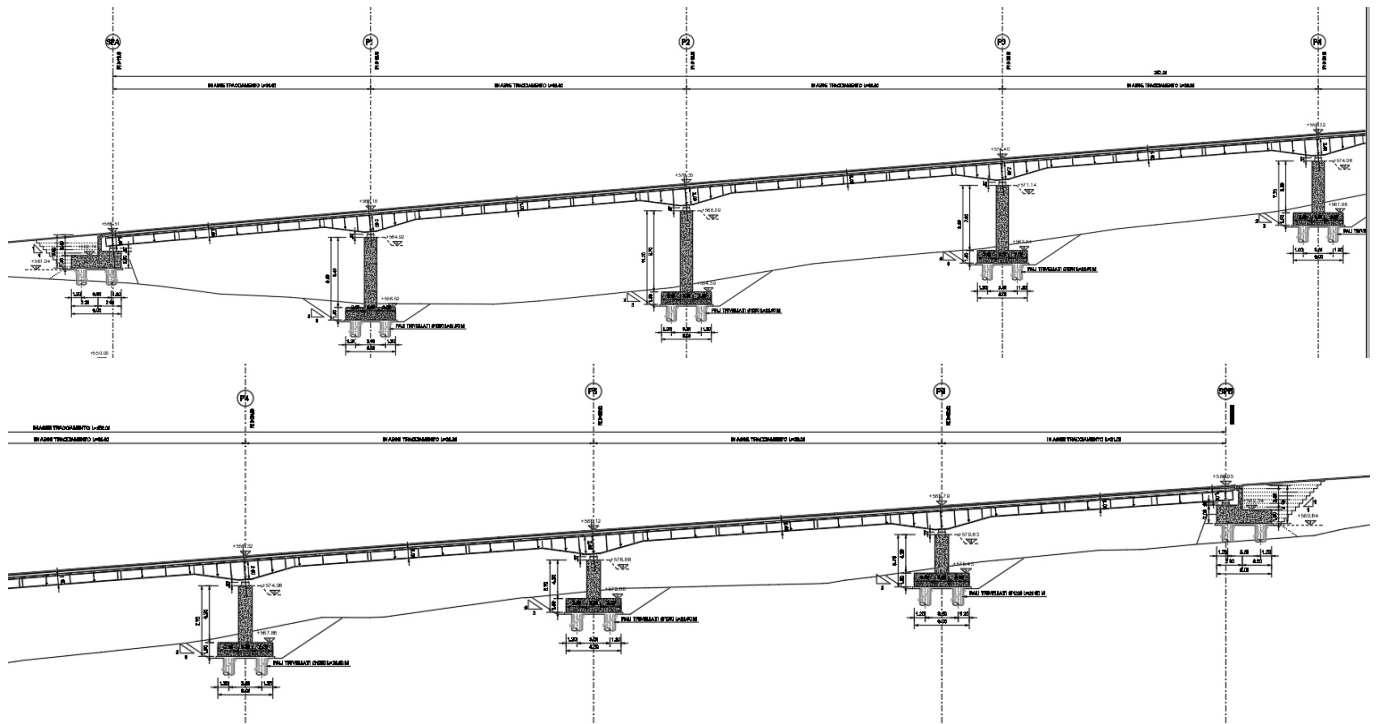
PROFILO LONGITUDINALE IMPALCATO
